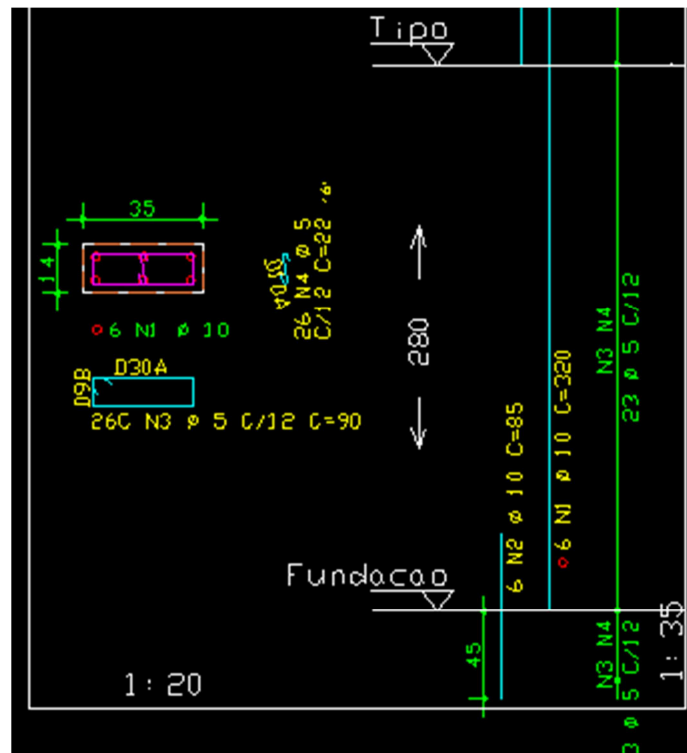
Detalhamento das armaduras de aço do Pilar 9 antes da aplicação do SISE.
